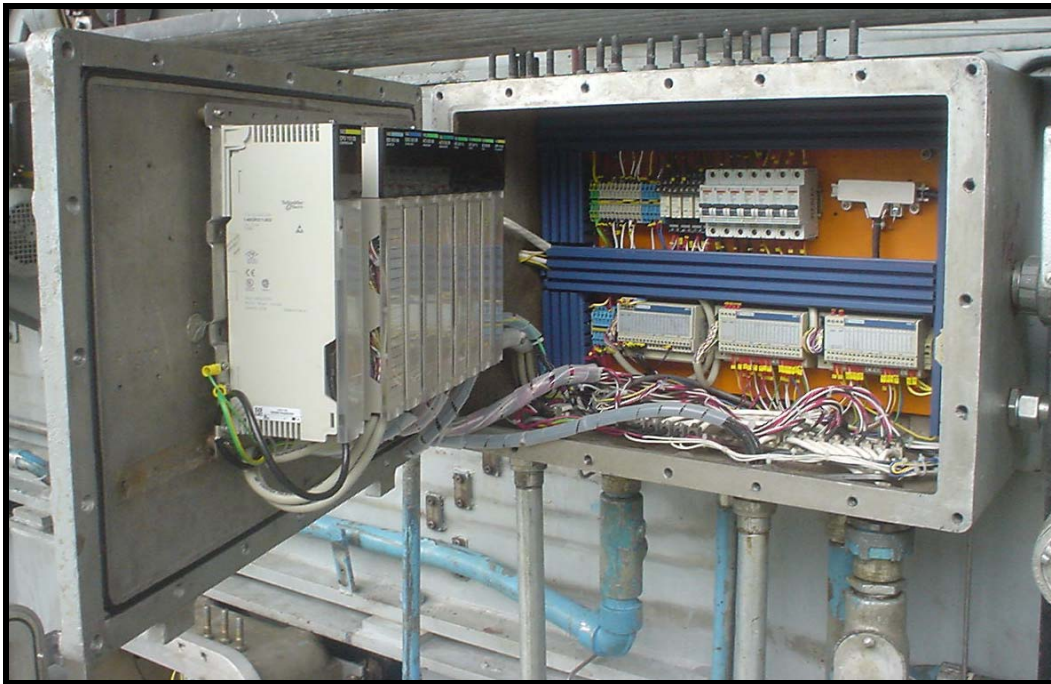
Finalización del proceso de cableado del grupo de bombeo
